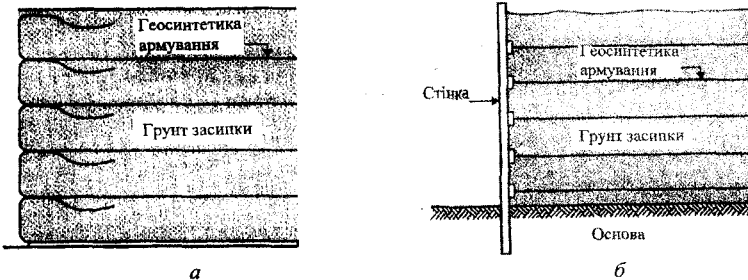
Схеми застосування геотекстильного матеріалу або геосинтетики в армоґрунтових підпірних стінках:
